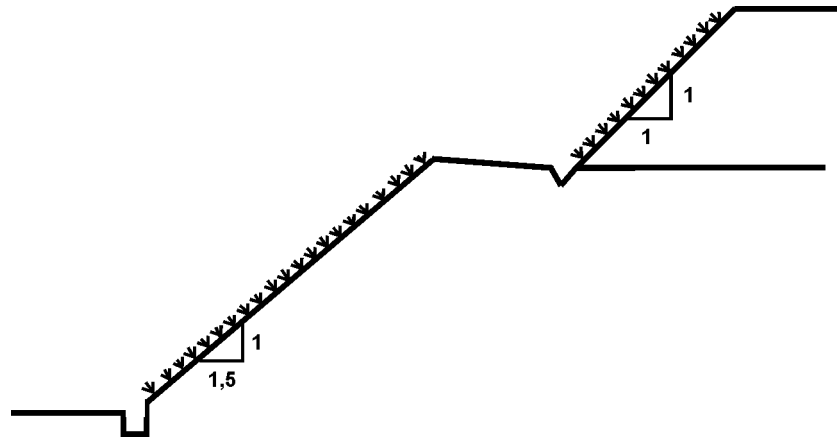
Corte em perfil de alteração – Retaludamento.
